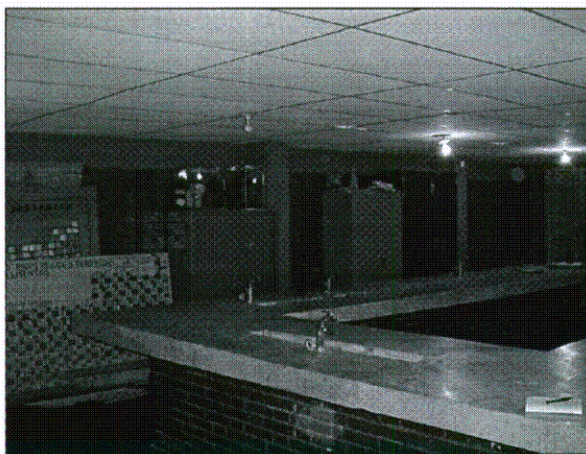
Vista de la pared norte del edificio donde funciona la biblioteca. Se observan cuatro (4) columnas en el antiguo salón de química, primer piso.
